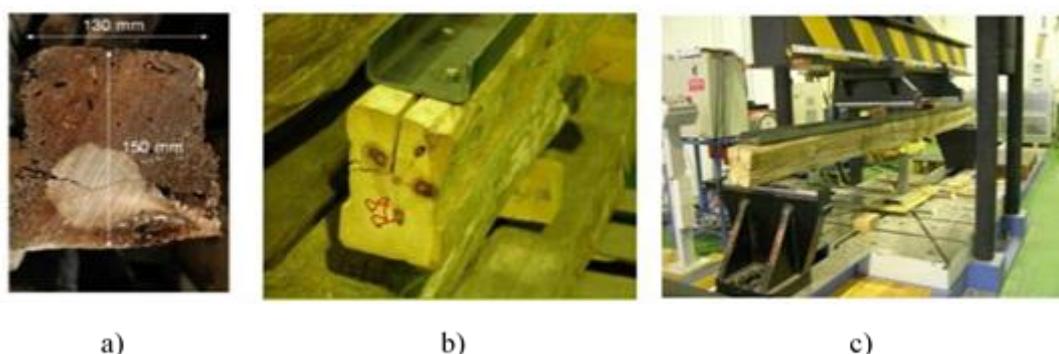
a) Exemplo de uma das vigas ensaiadas (e. a. González-Bravo, 2010) ; b) Exemplo de viga de madeira com perfil metálico na face superior (C. González-Bravo, 2007); c) Ensaio de flexão de viga de madeira reforçada (C. González-Bravo, 2007)
